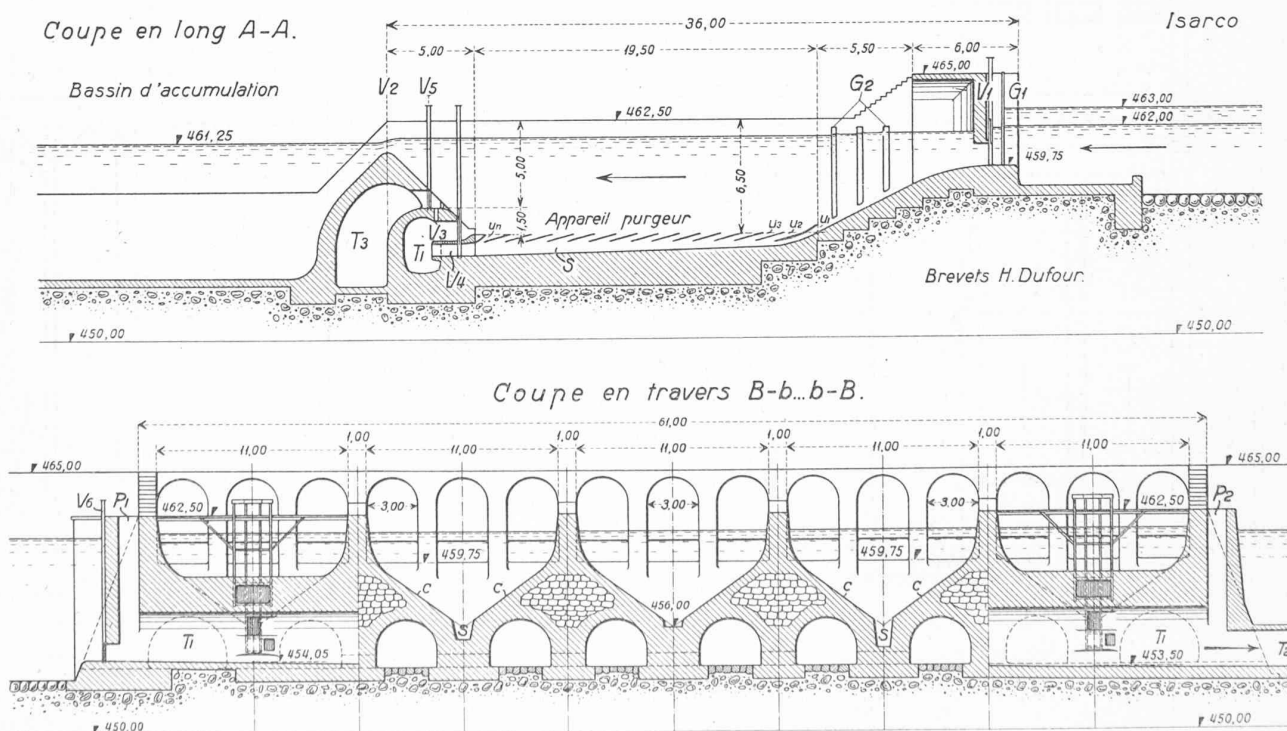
Coupe en long et coupe en travers du dessableur de Ponte all' Isarco. Echelle 1 : 400.
